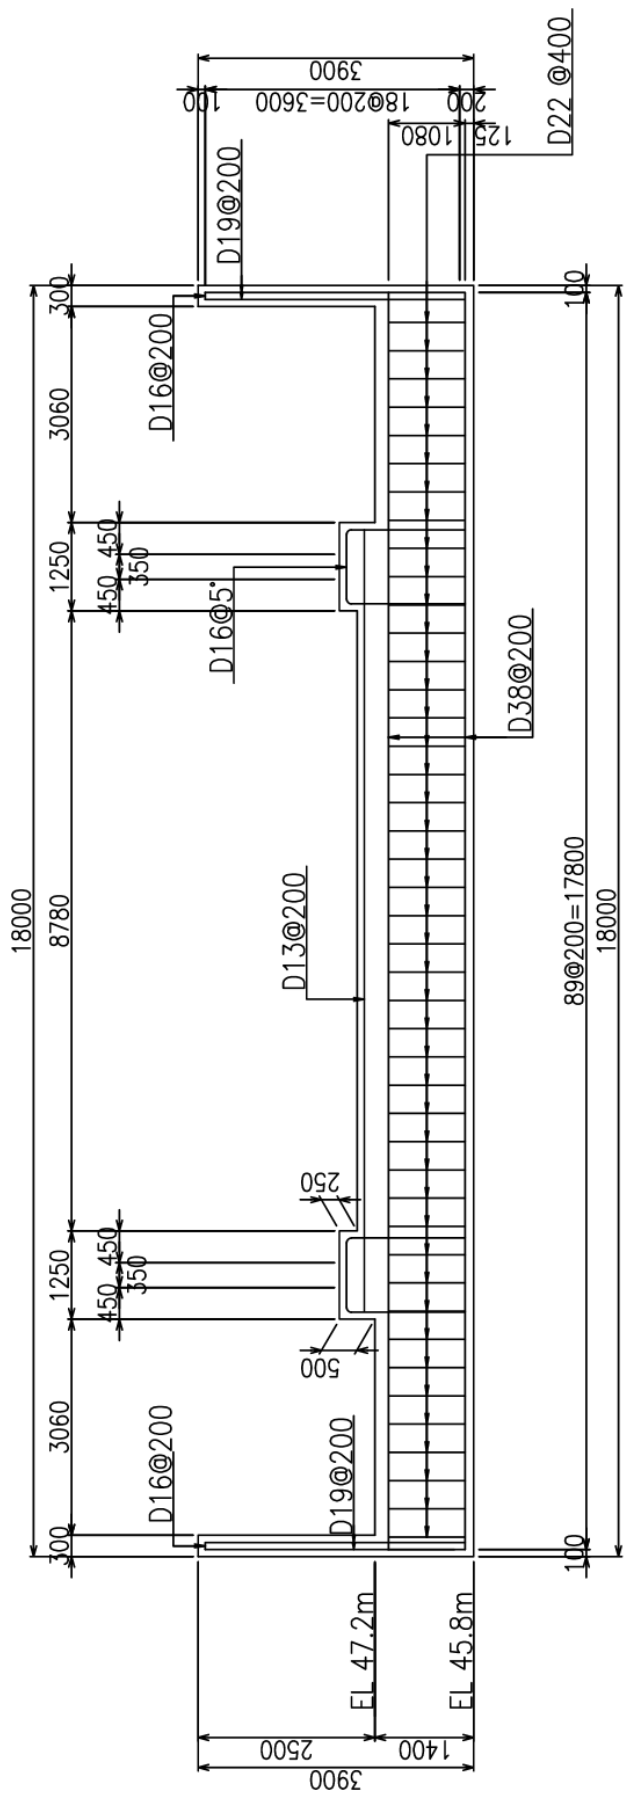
ガスタービン発電機用軽油タンク基礎断面図 (A-A 断面及び B-B 断面)
